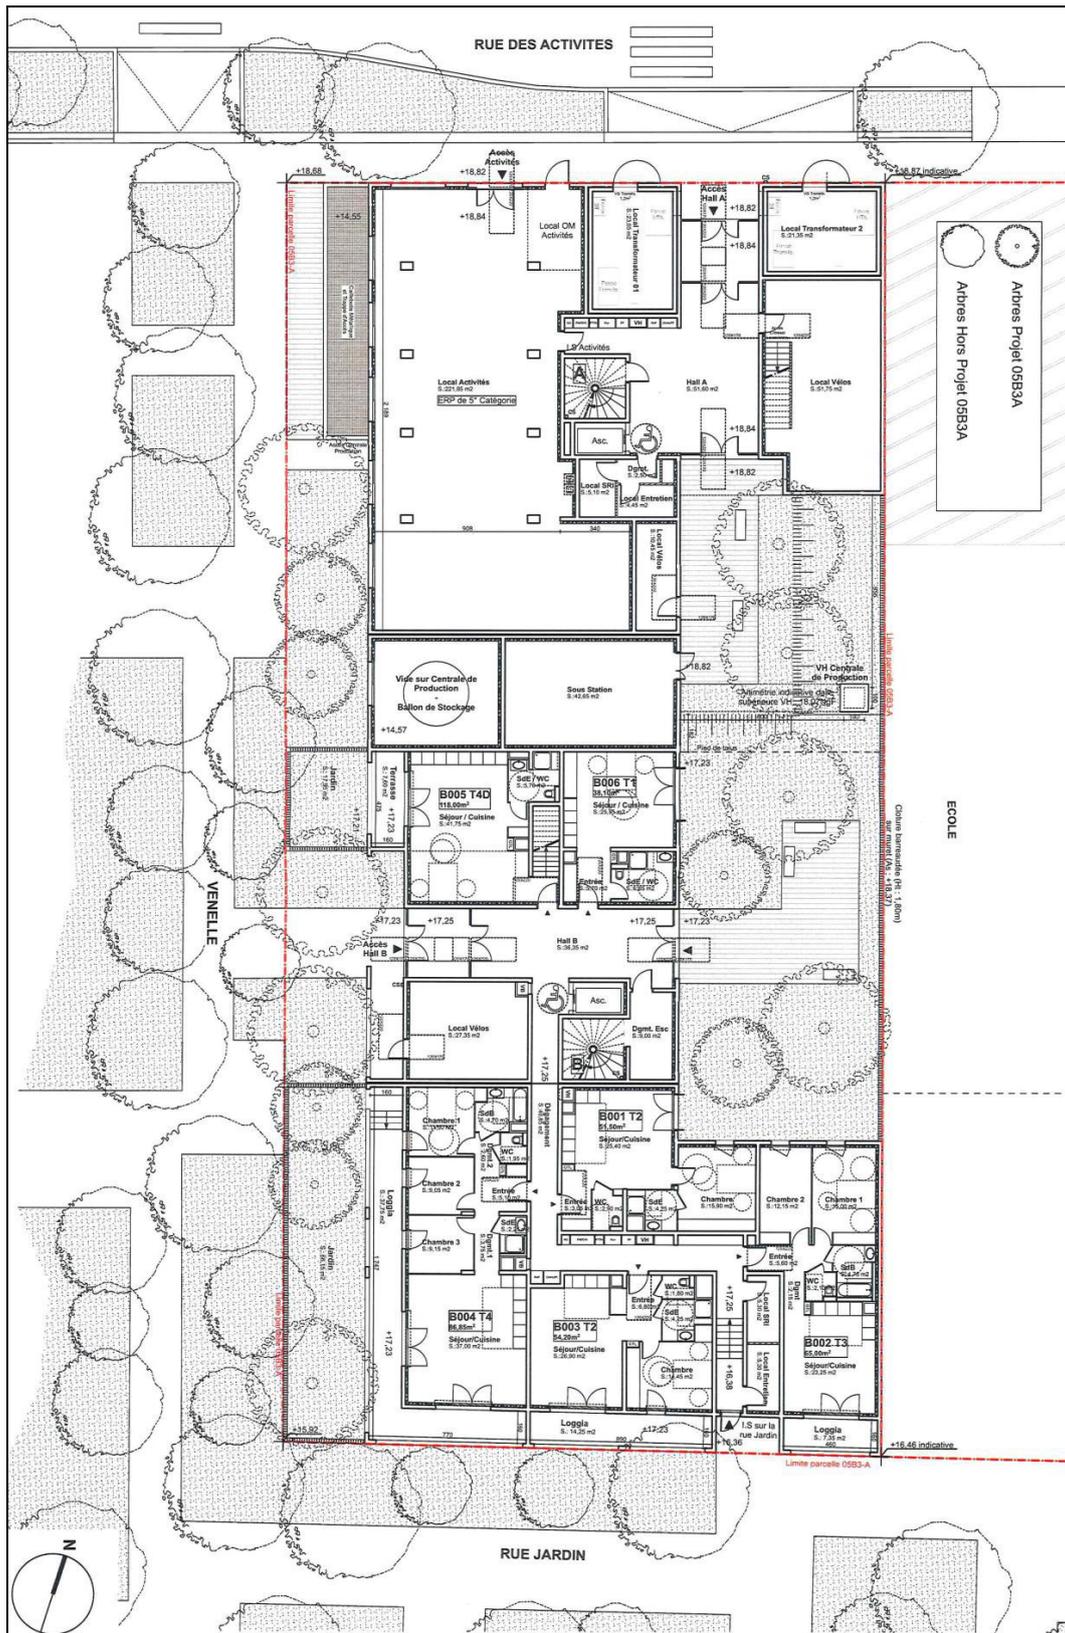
Plan du rez-de-chaussée (source : Linkcity)
